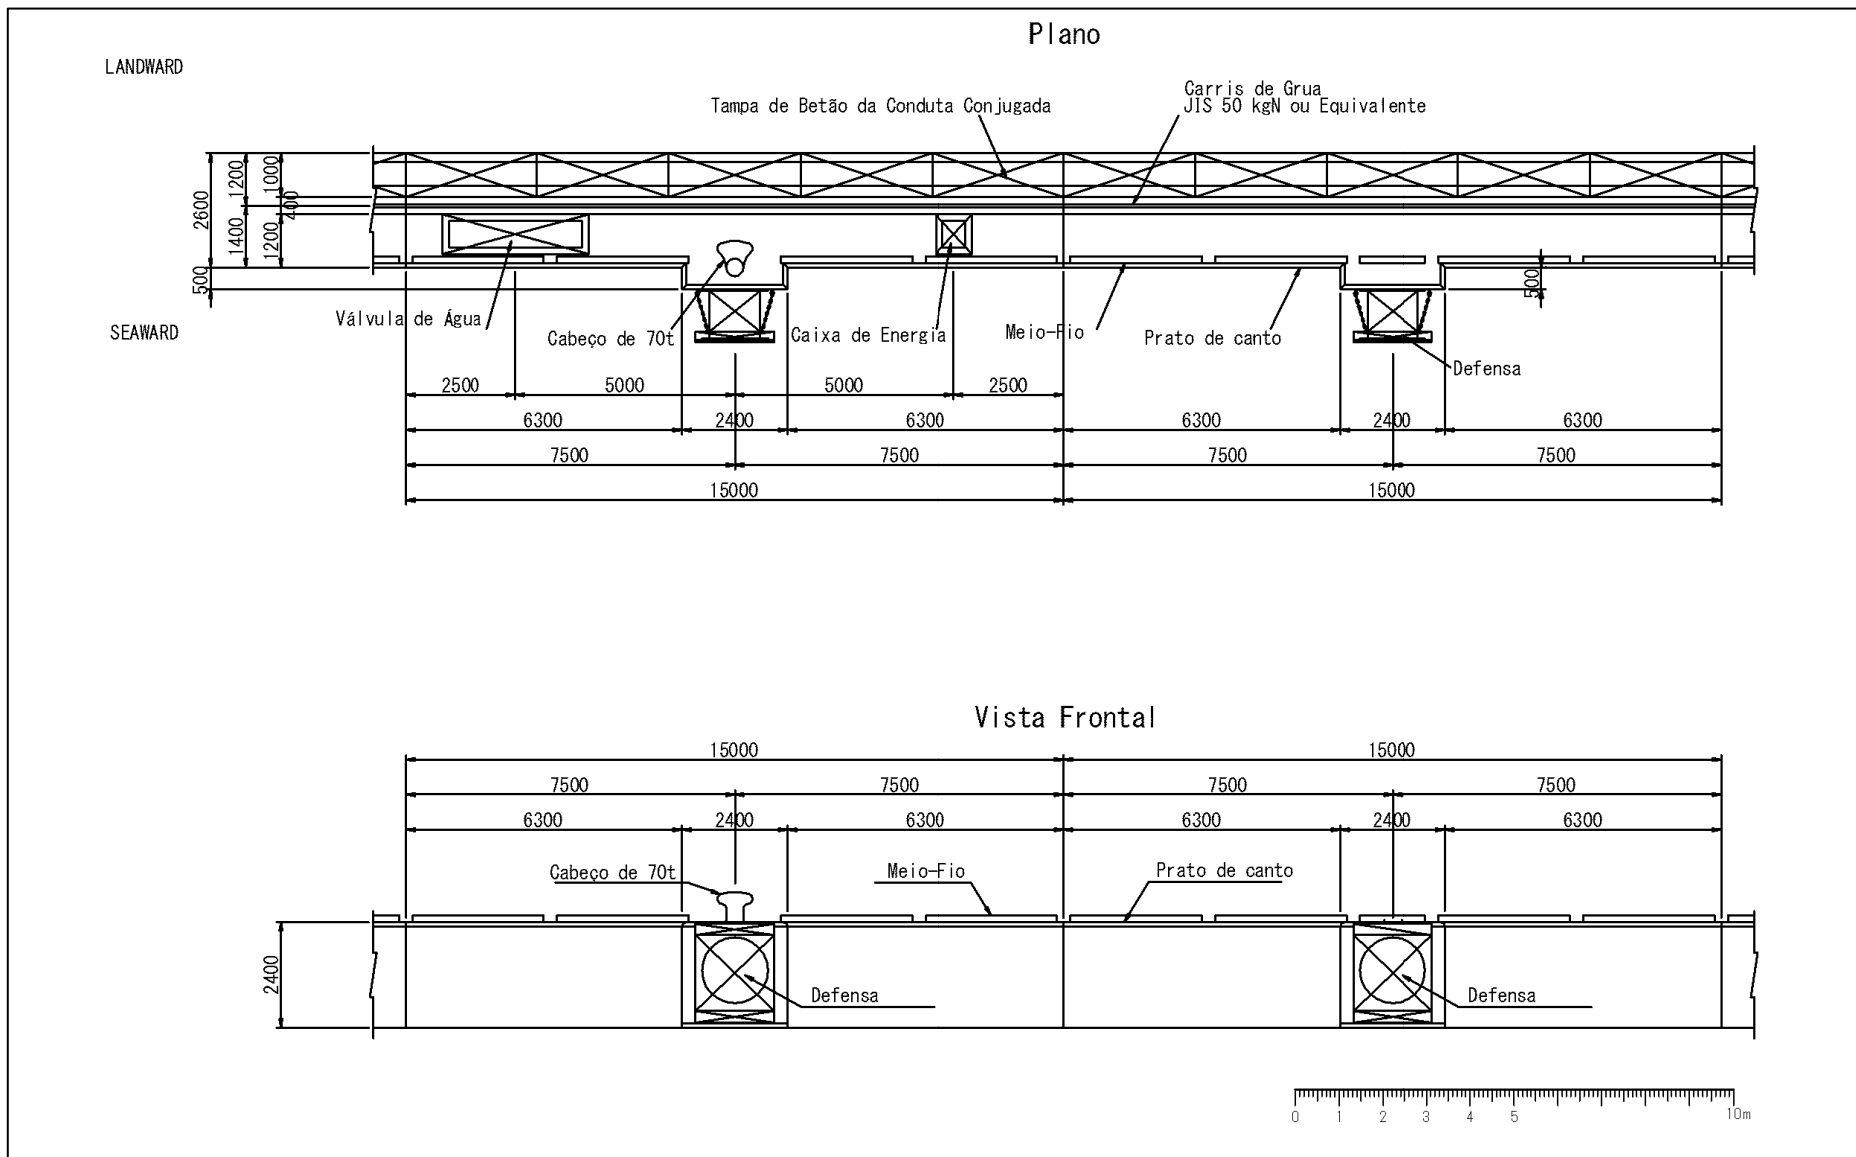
Planta Planimétrica da Estrutura do Coroamento do Muro
